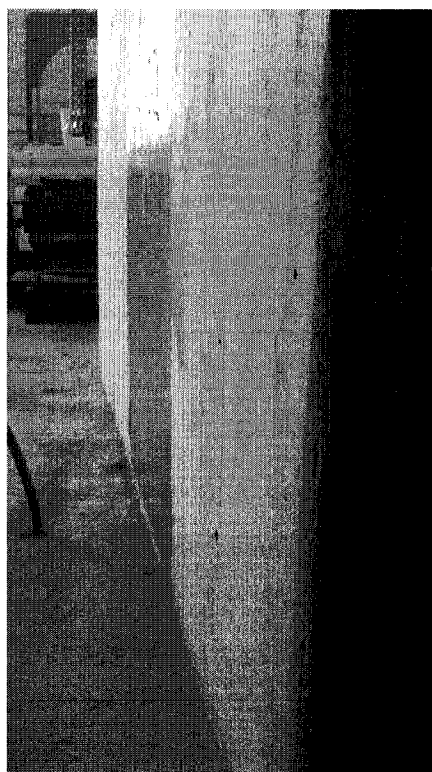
Photo de la réparation de la face ouest du pilier 3
